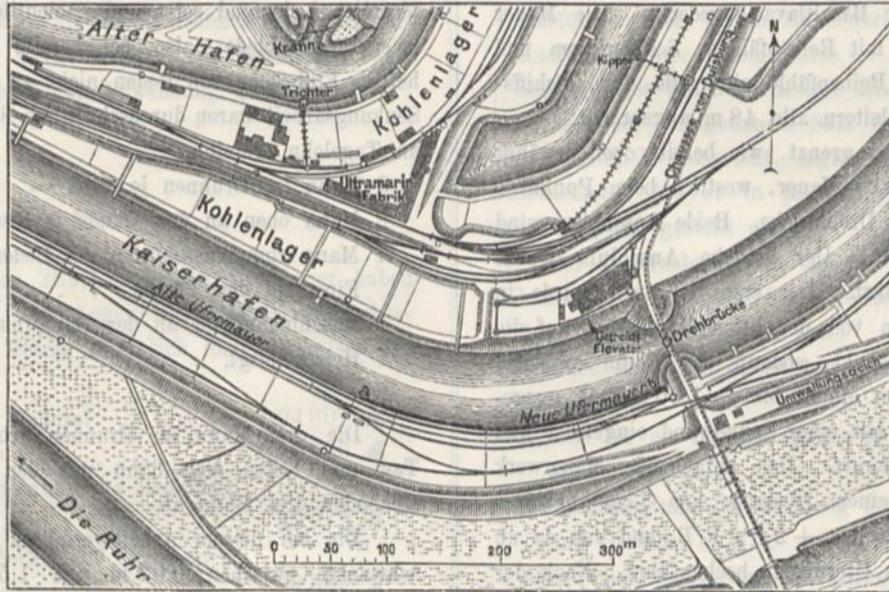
Lageplan der Ufermauer am Kaiserhafen von Ruhrort.
